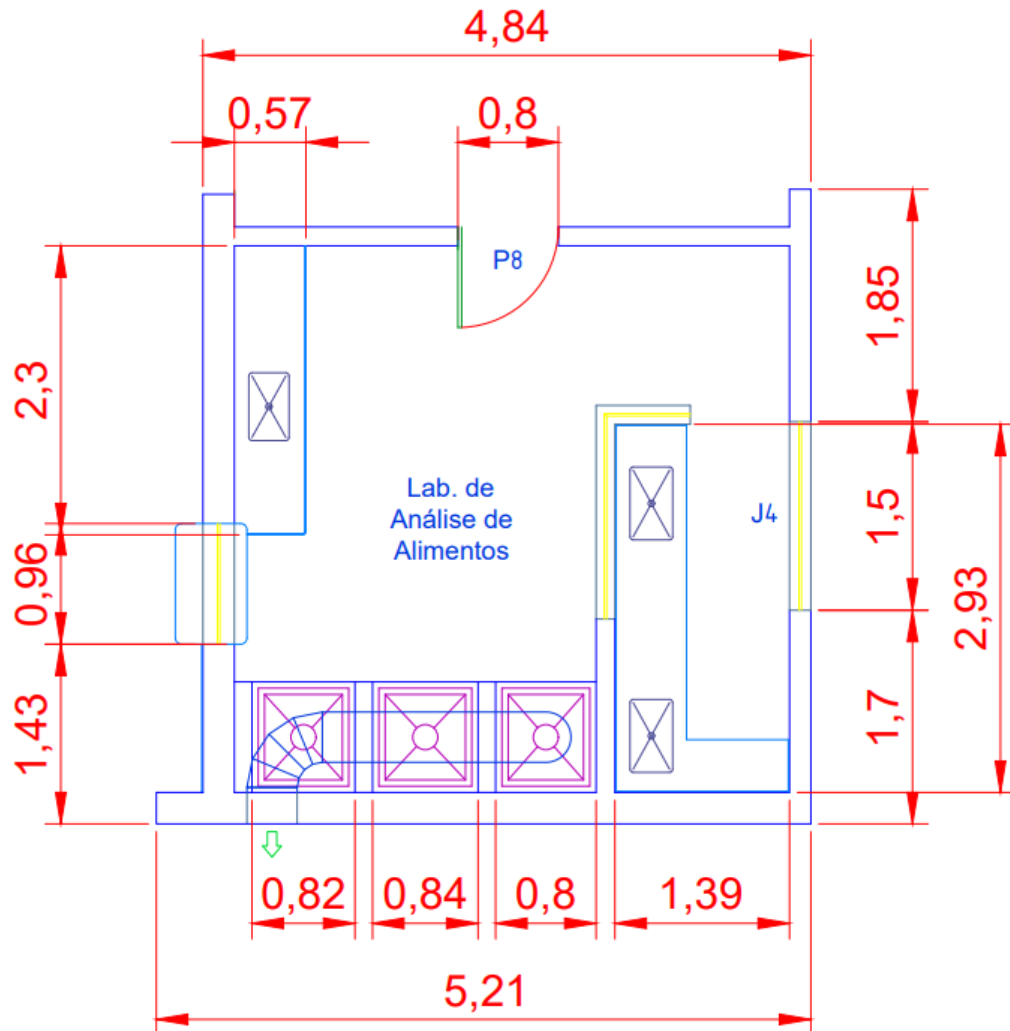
Planta do laboratório feita com o Software Autocad 2008 versão acadêmica com as cotas em metros.
